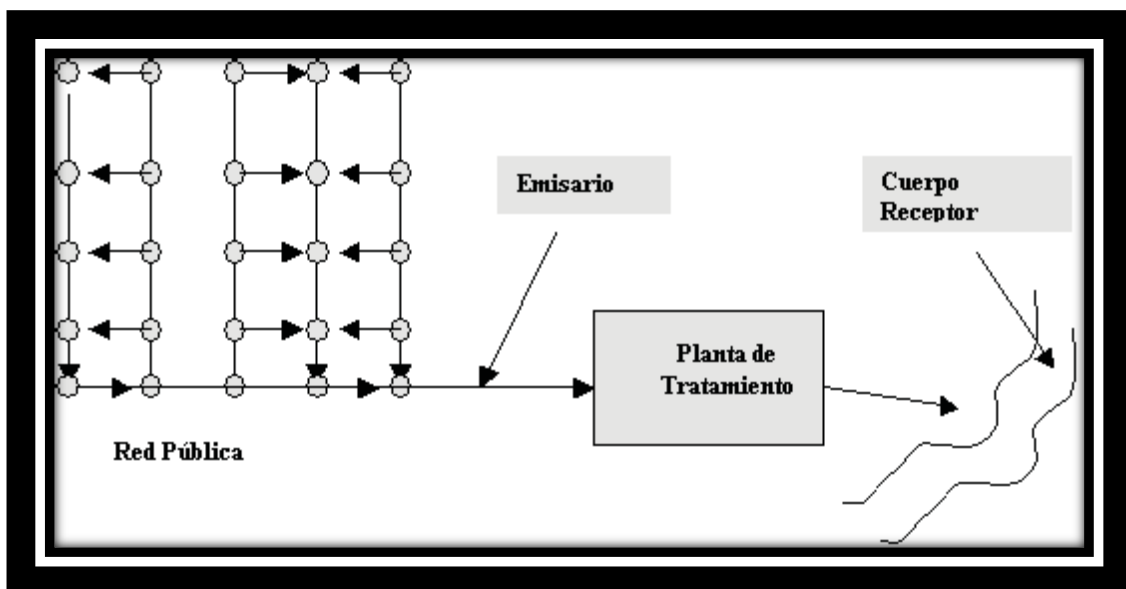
VISTA EN PLANTA “SISTEMA DE ALCANTARILLADO”
